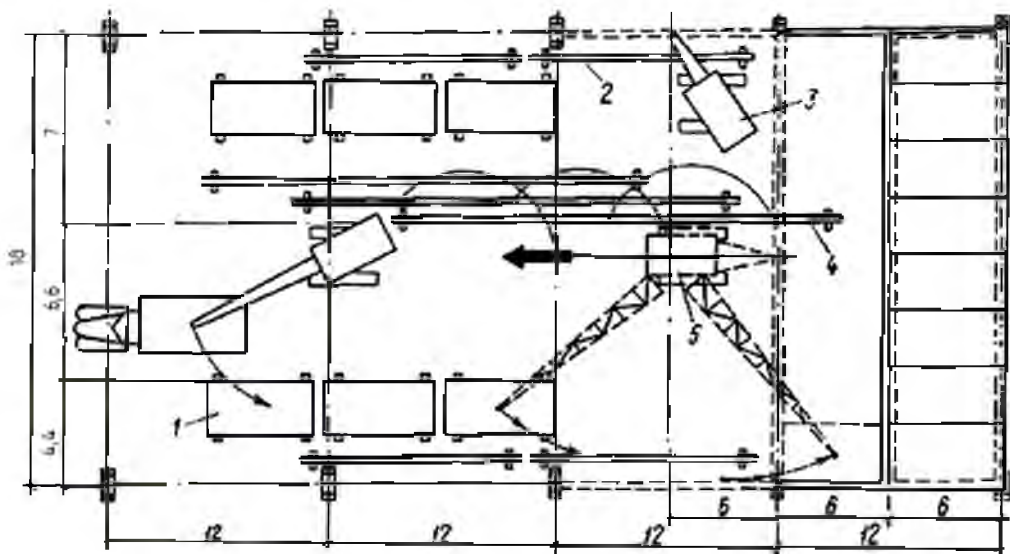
Попередня розкладка конструкції при монтажі покриття одноповерхової громадської будівлі виглядає так: 1 - панелі покриття; 2 - підкроквяні арки; 3 - кран на монтажі підкроквяних арок; 4 - кроквяні арки; 5 - основний монтажний кран
